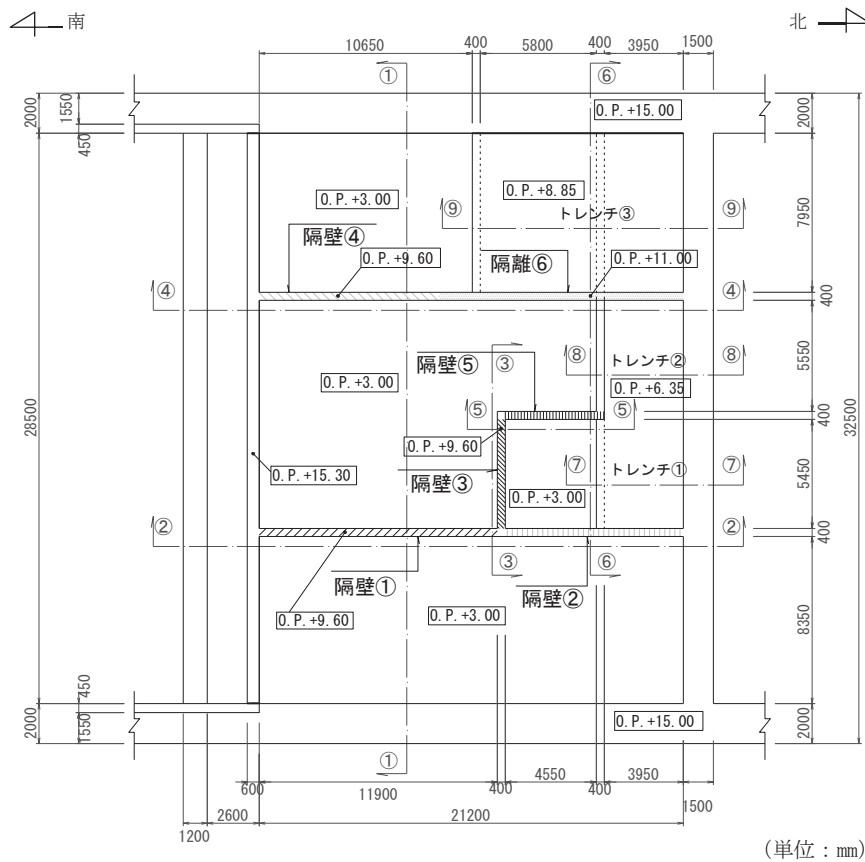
海水ポンプ室補機ポンプエリアの平面図
